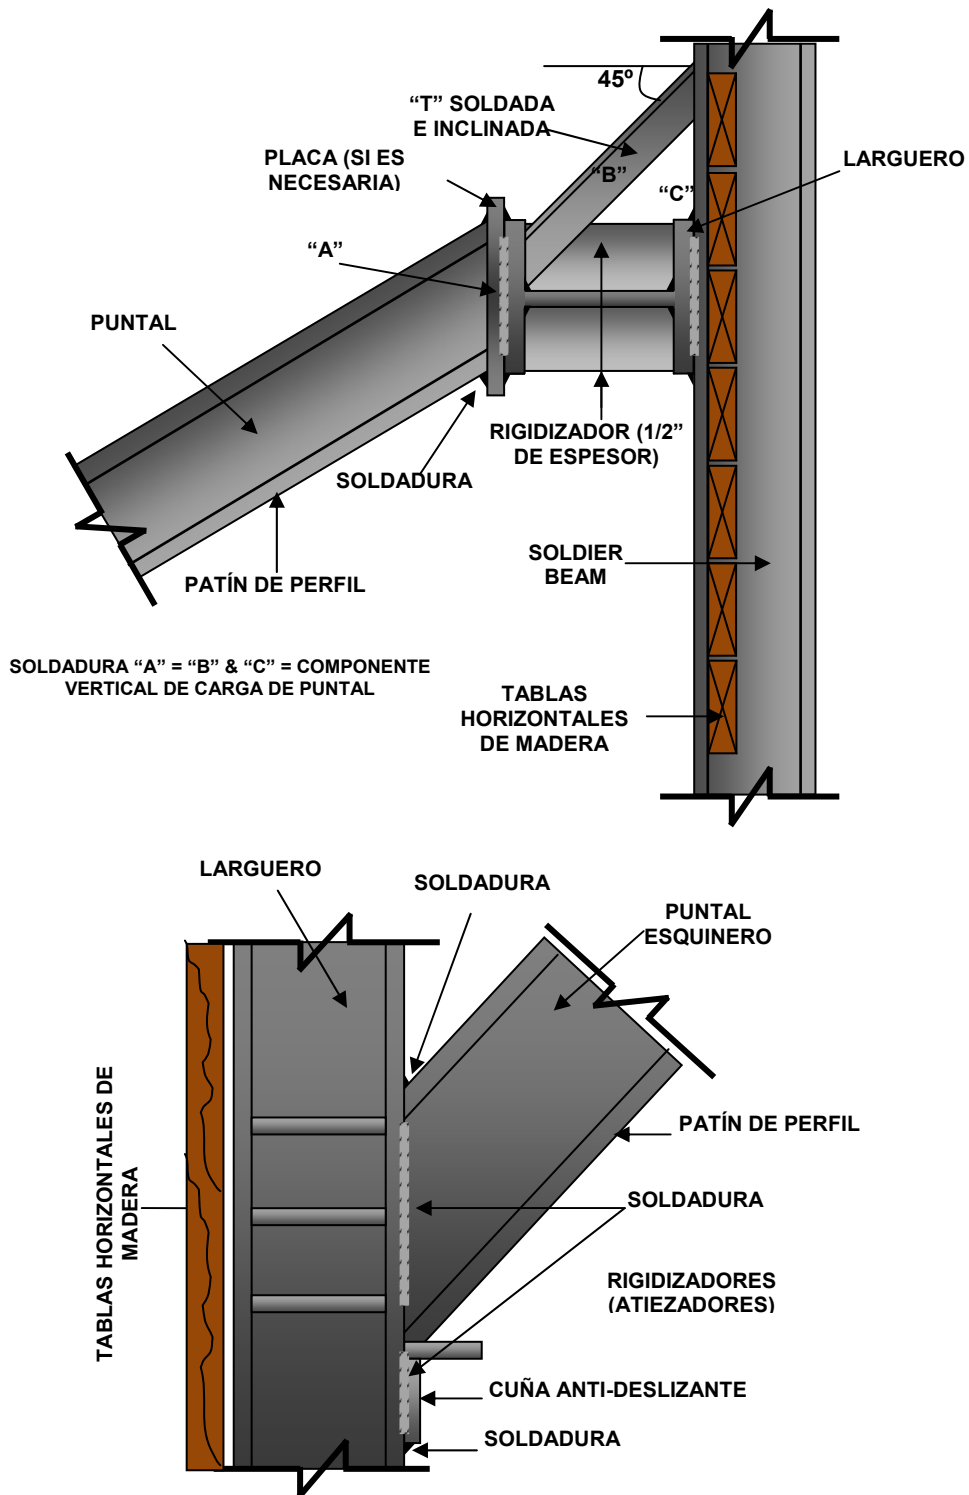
Detalles de conexiones entre el puntal y el larguero con soldadura.
